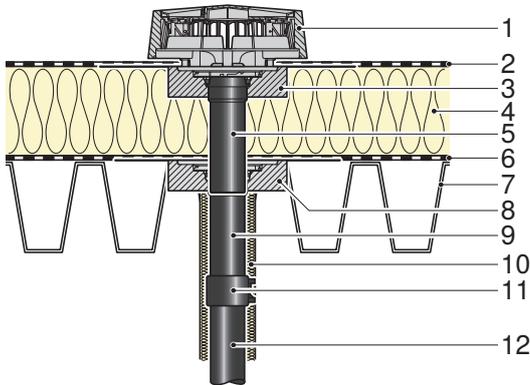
Монтаж на изолированной легкой кровле с битумным кровельным покрытием
